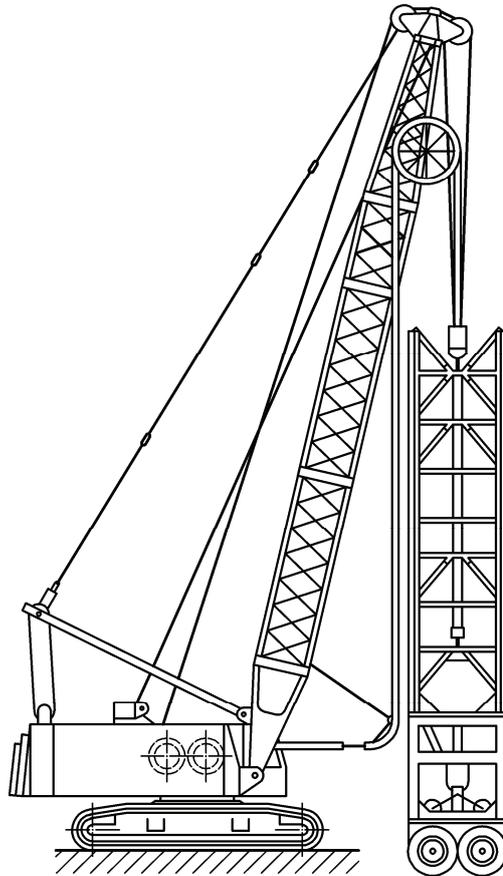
Seilbagger auf Kettenlaufwerk mit Schlitzwandfräsausrüstung
